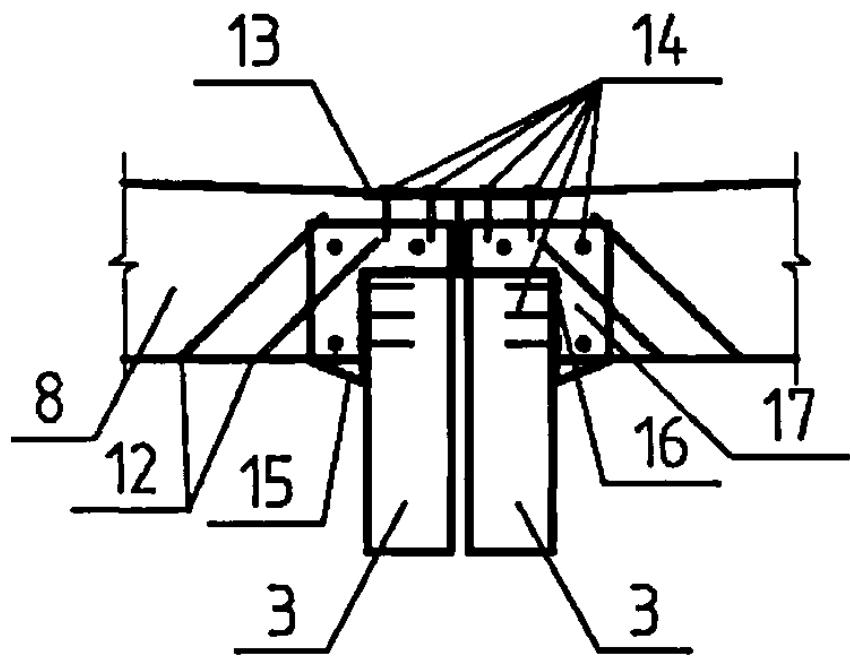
Соединение крупноразмерных двухскатных клееванерных плит с верхним поясом деревометаллической фермы с помощью металлических башмаков
